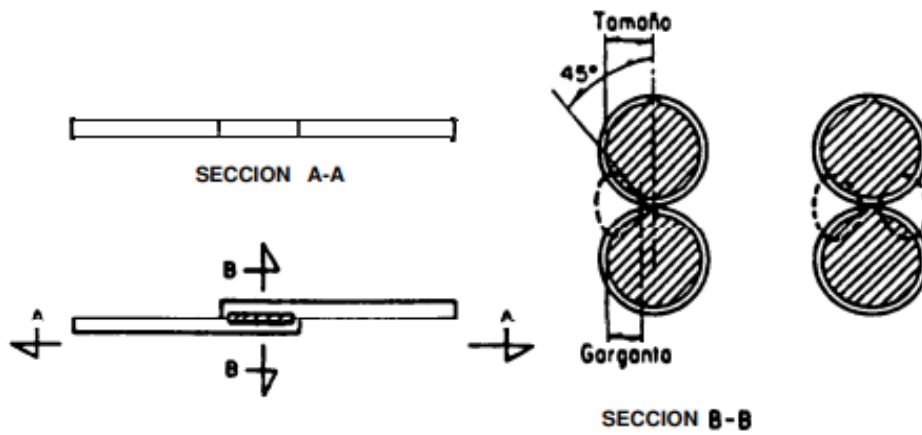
Soldadura de filete por medio de traslape [2].
